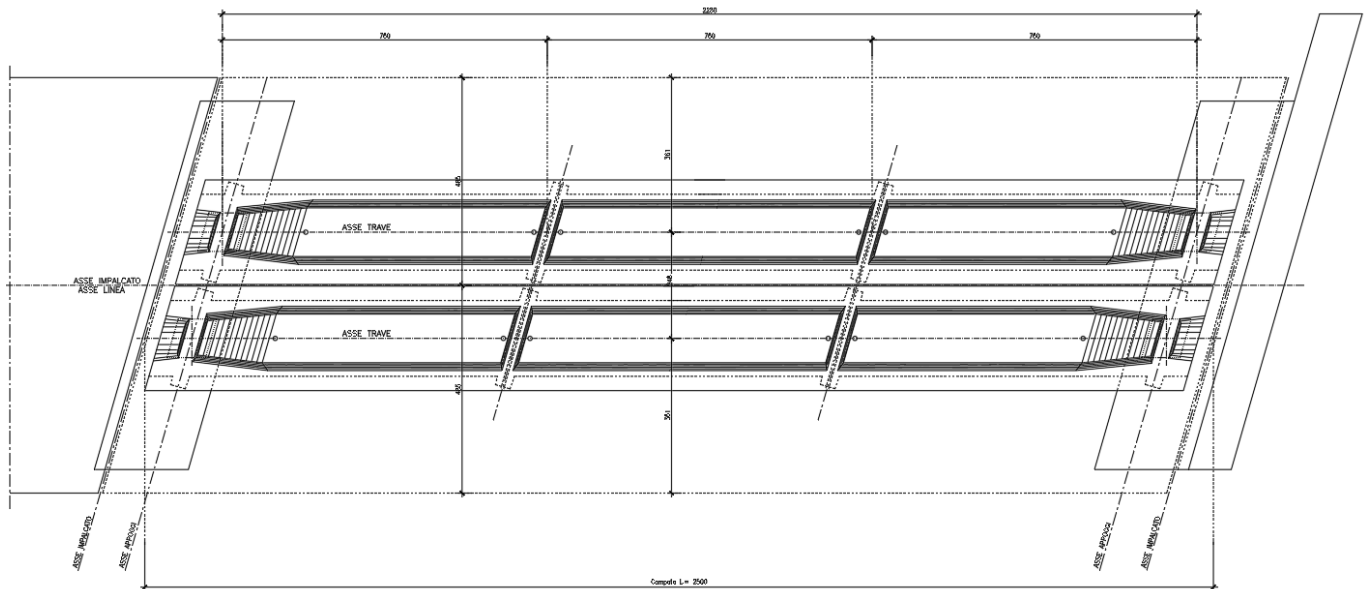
Pianta dell'impalcato (quota intradosso soletta)
